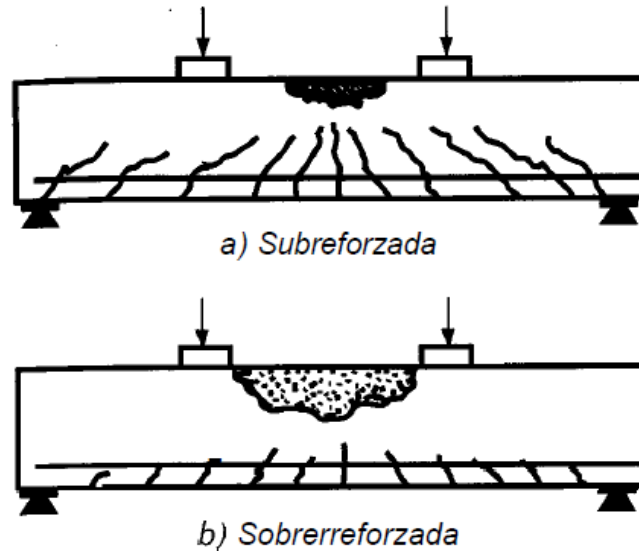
Agrietamiento de las vigas de acuerdo al porcentaje de acero
